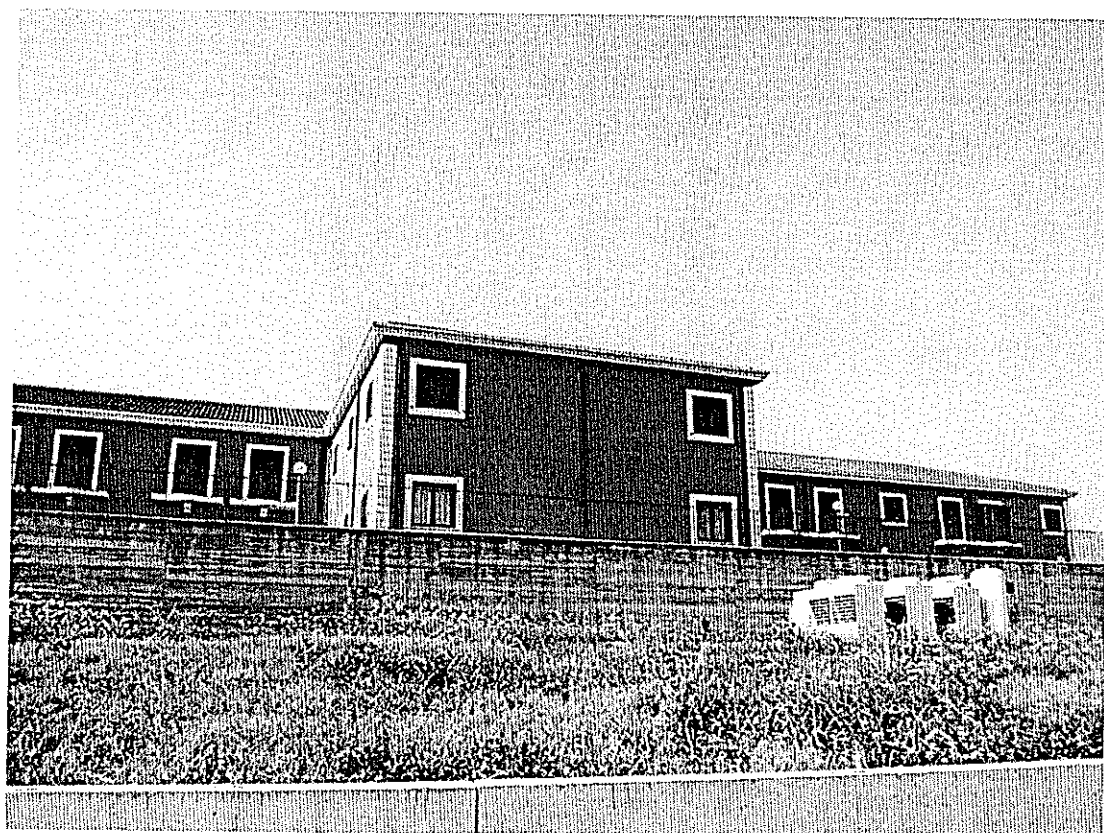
Muri a sostegno della corte esterna e dei fabbricati.
